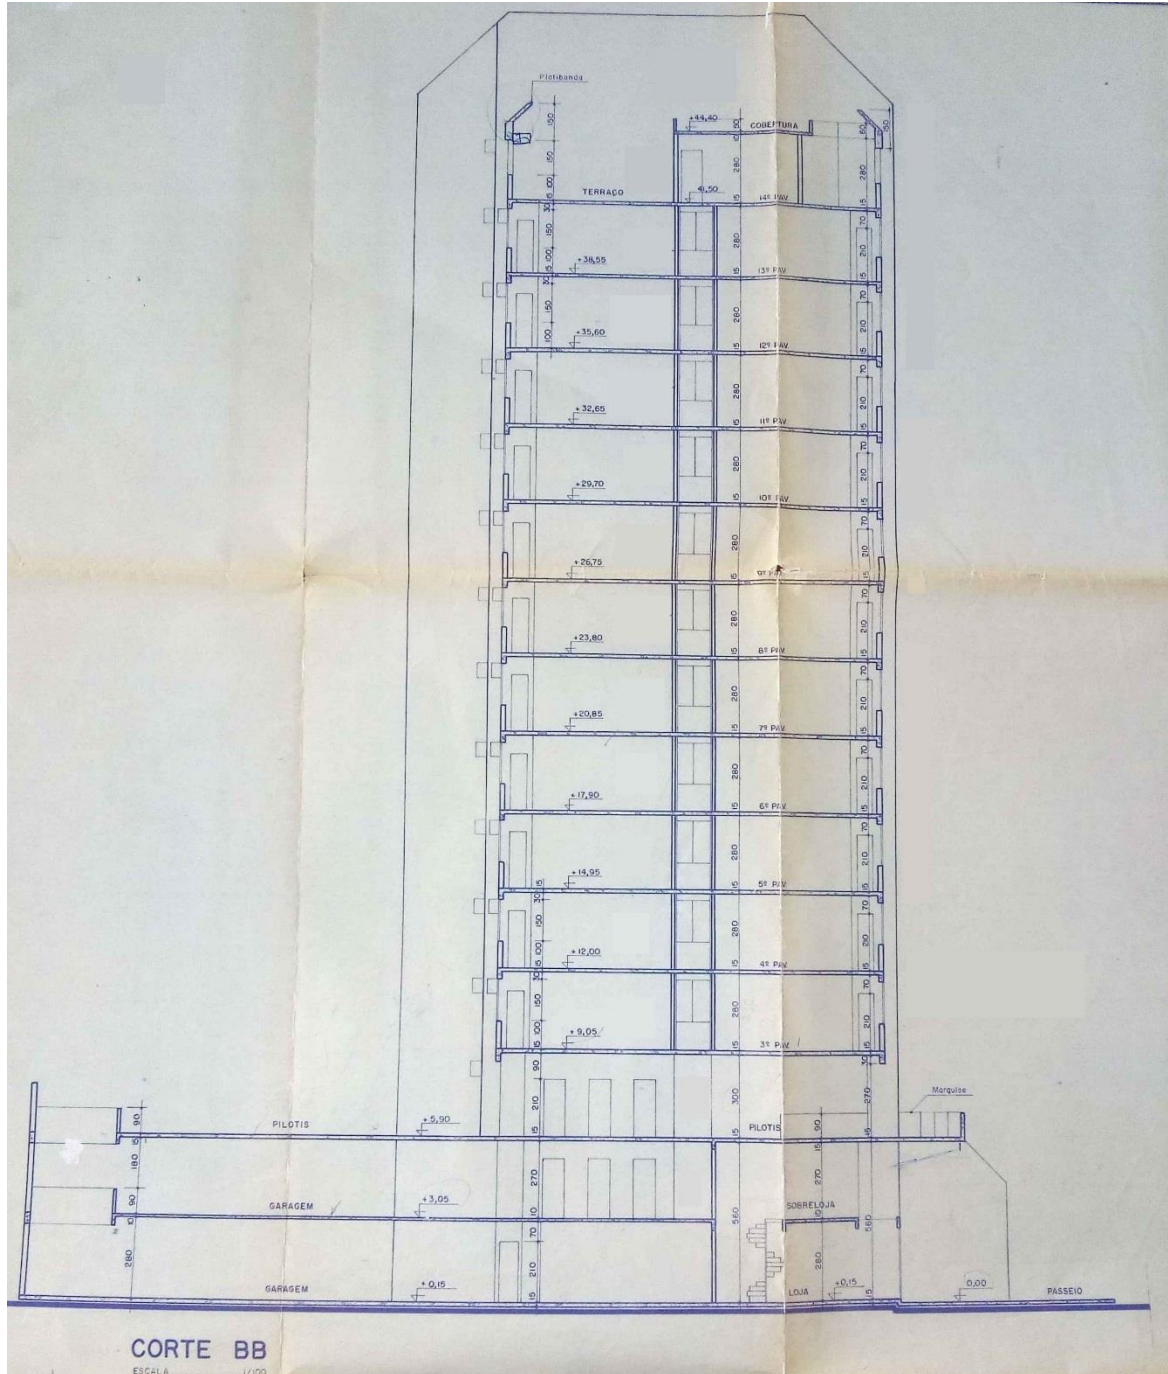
Corte Transversal do projeto arquitetônico.
